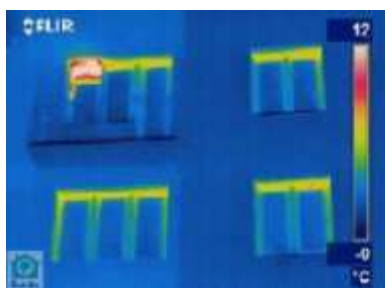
Dům bez izolace - původní dřevěná okna, převzato a upraveno z [22]
